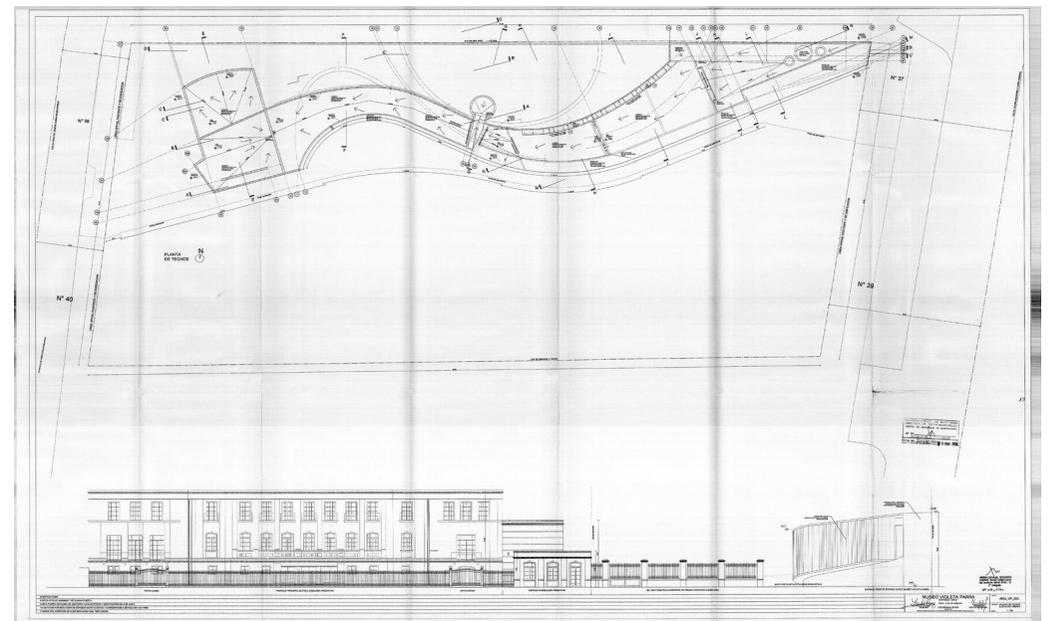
Planimetría Museo Violeta Parra. Fuente: Santiago Ilustre Municipalidad, 2021
